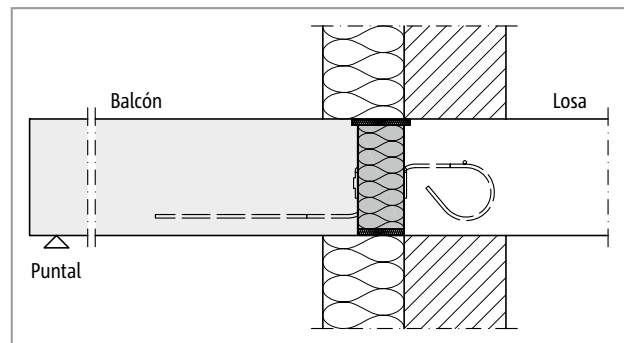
Schöck Isokorb® T tipo Z, Q: Sistema de aislamiento térmico exterior (SATE)
